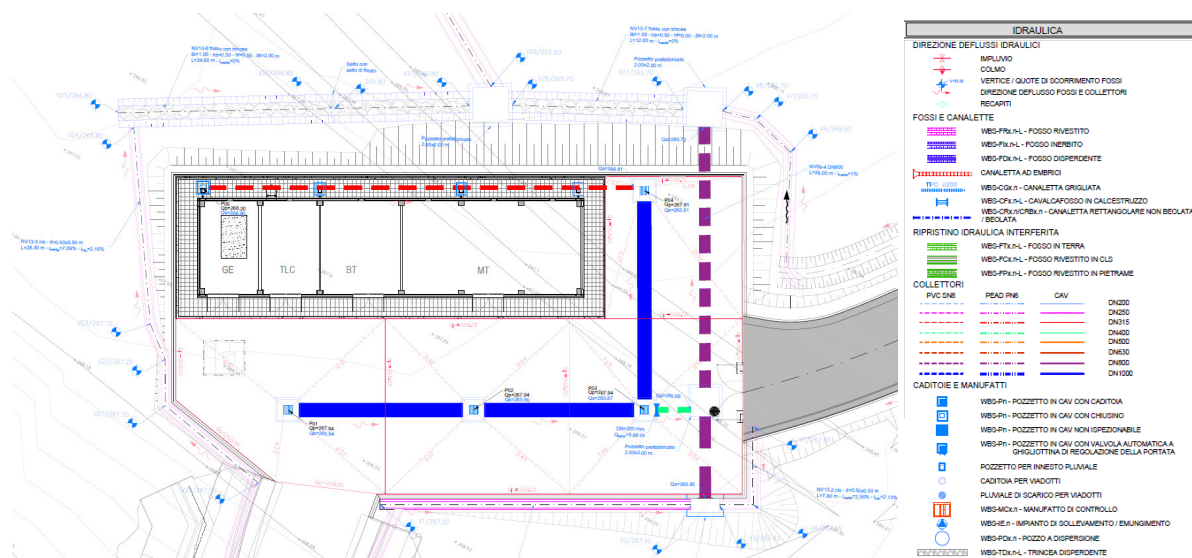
Planimetria della sistemazione del piazzale RI59 come da prescrizione in oggetto
